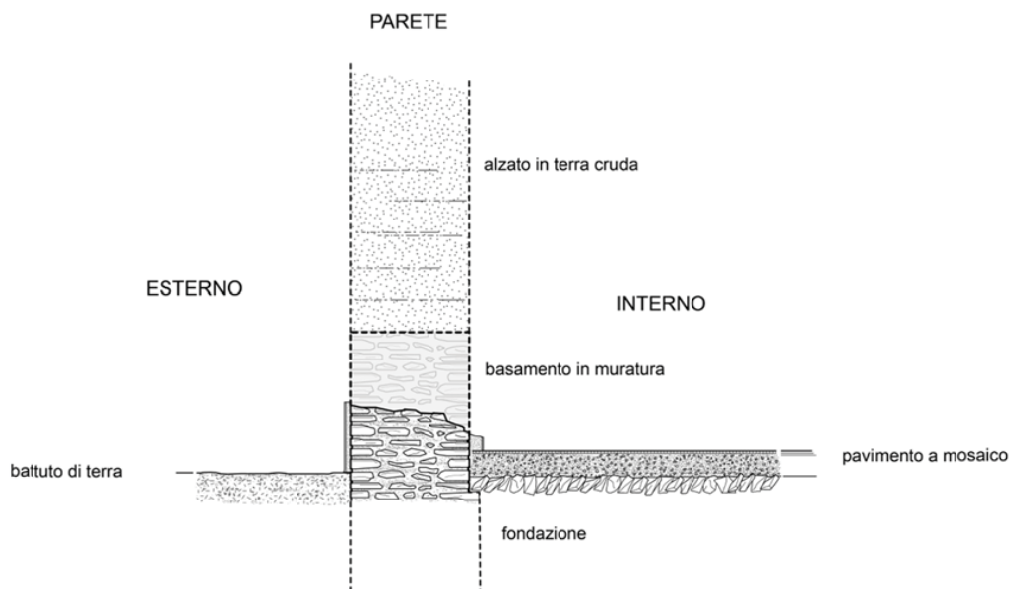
Schema della tecnica costruttiva delle strutture murarie
